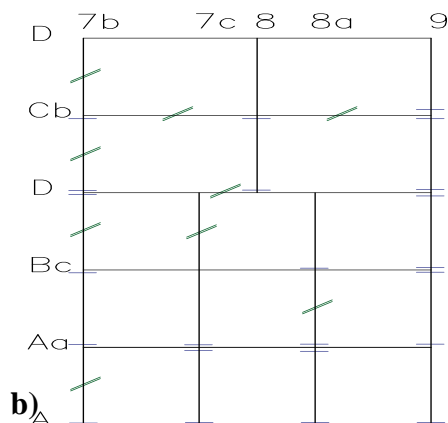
y 7b. Daño en vigas de primer piso alto, de Silos de Harina. Nivel 3.50 m. y esquema de fisuras
